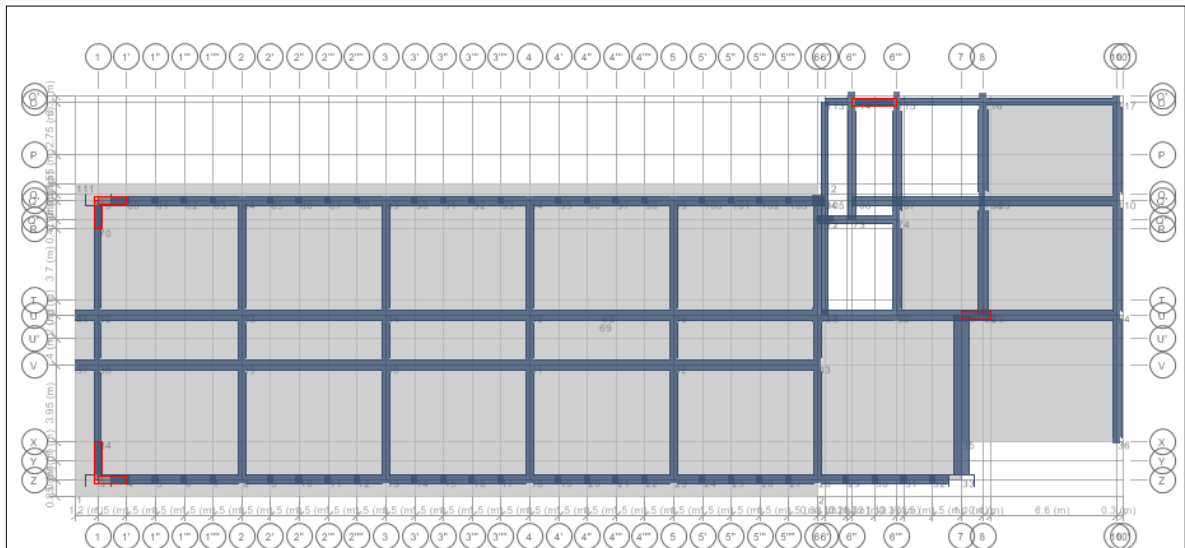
Muros estructurales (rojos) Estructura 5.1
